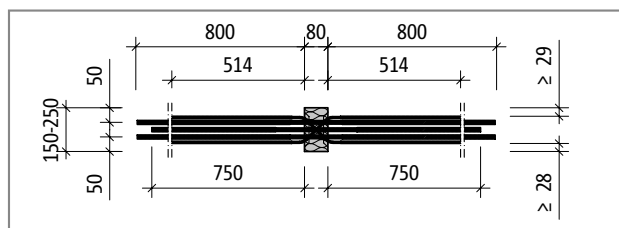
Schöck Isokorb® typ W20M: Řez prvkem
